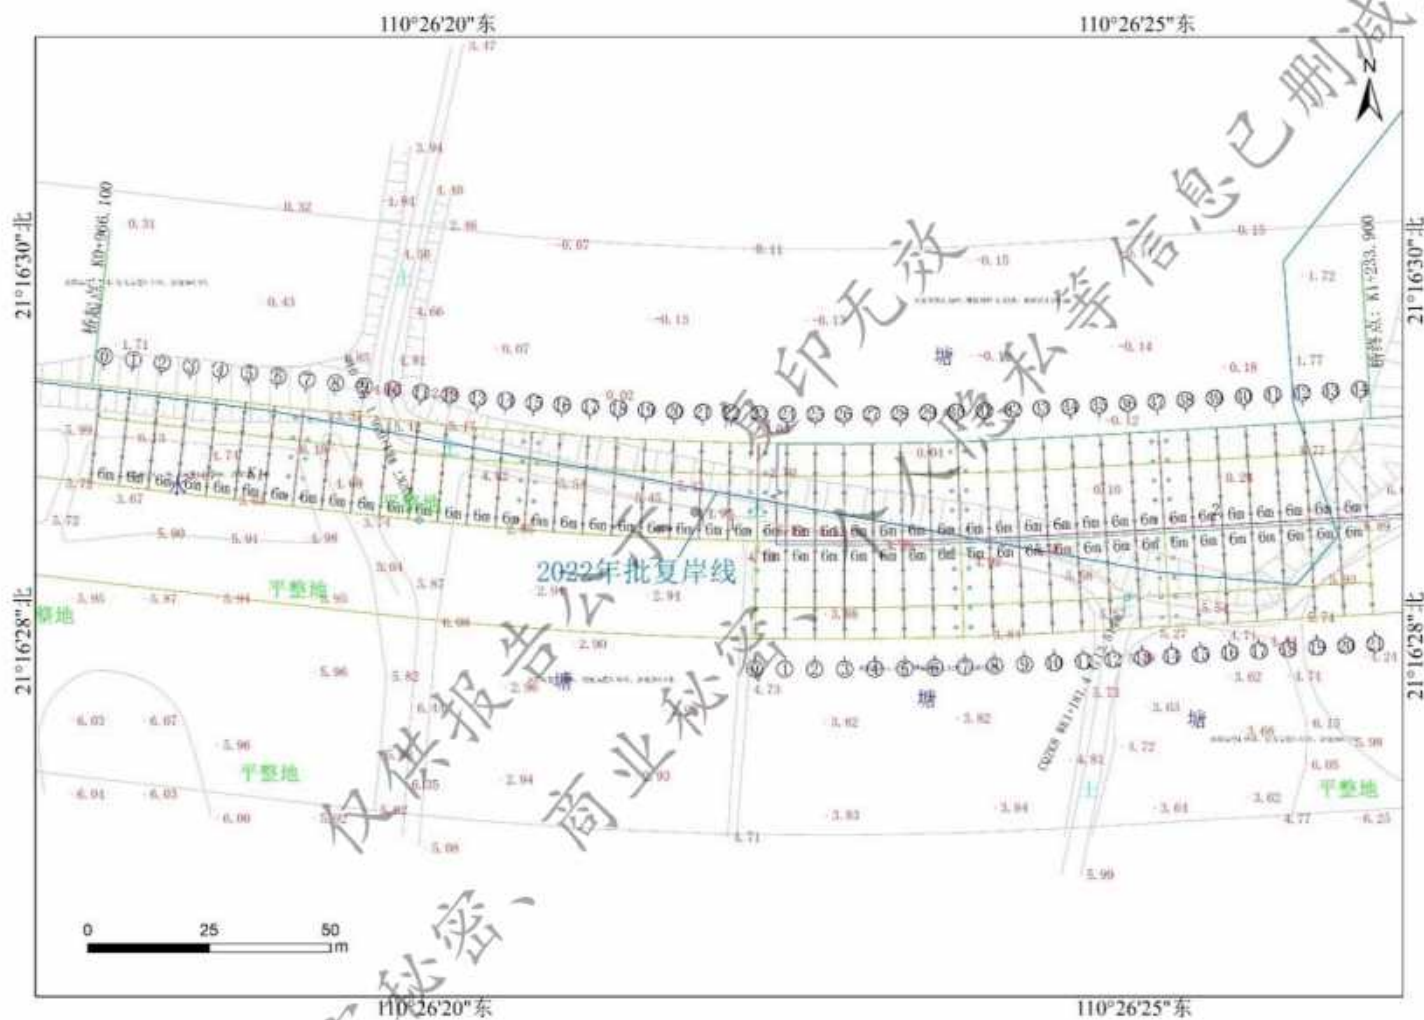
海旺路 2 号桥总平面布置图 (1)
